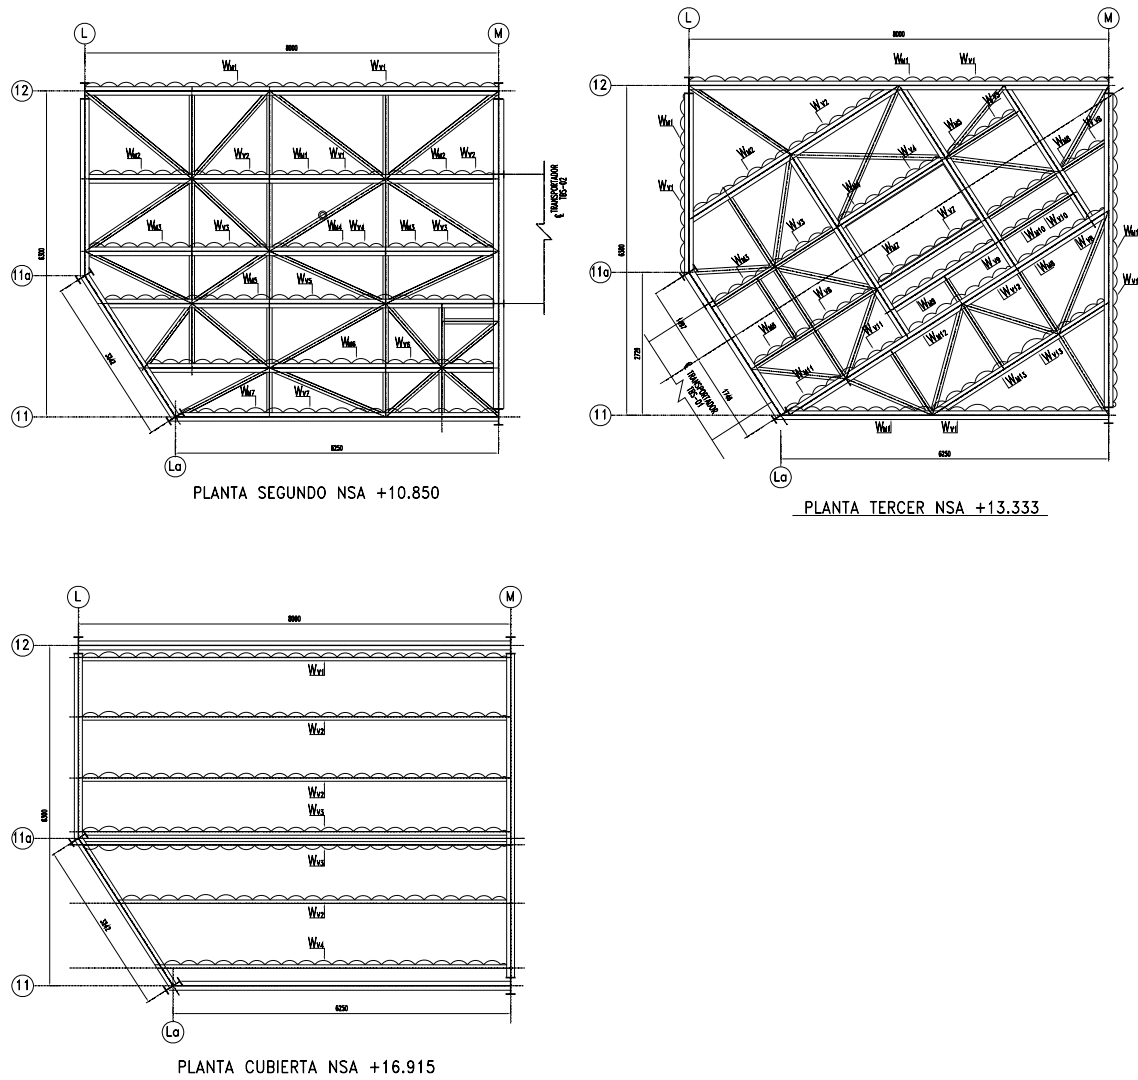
Plantas de Operación TT-2, con cargas distribuidas y estructuración.
